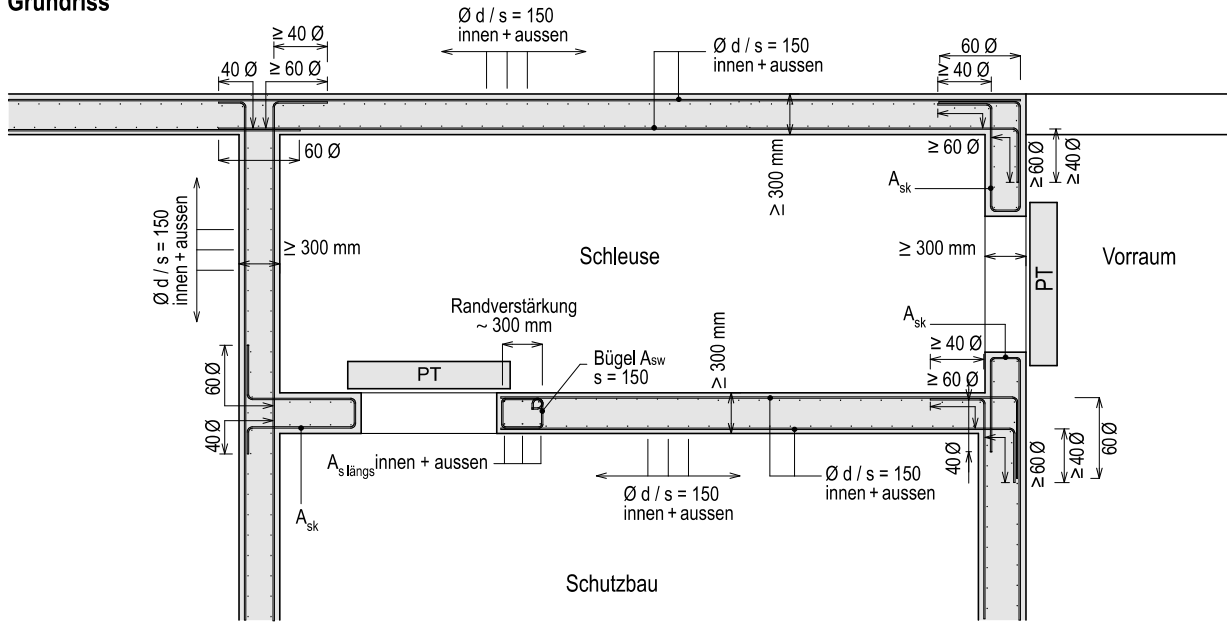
Grundriss zur Wandbewehrung (Bügel in den Wänden nicht eingezeichnet)
